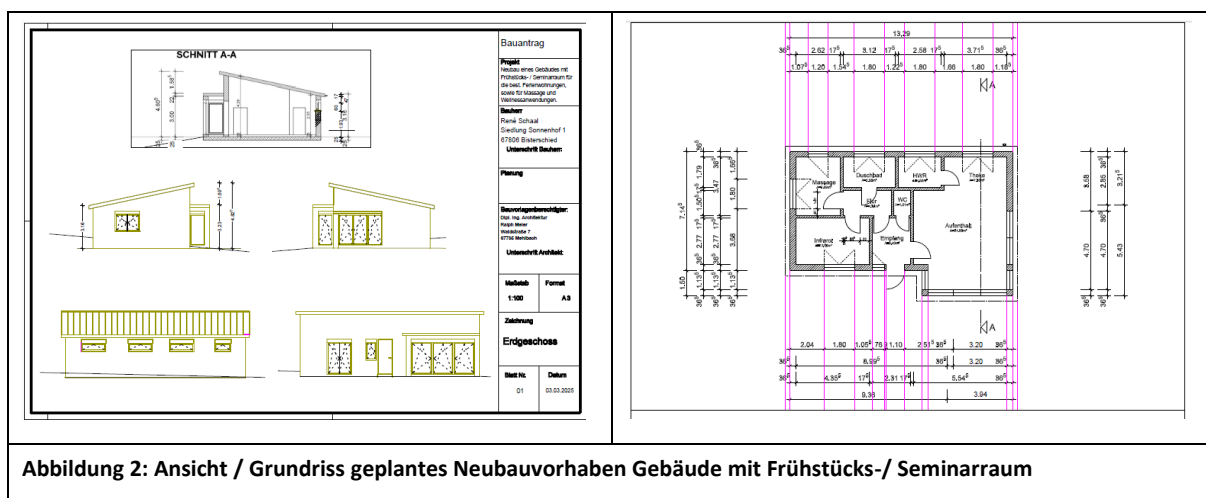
Ansicht / Grundriss geplantes Neubauvorhaben Gebäude mit Frühstücks-/ Seminarraum
